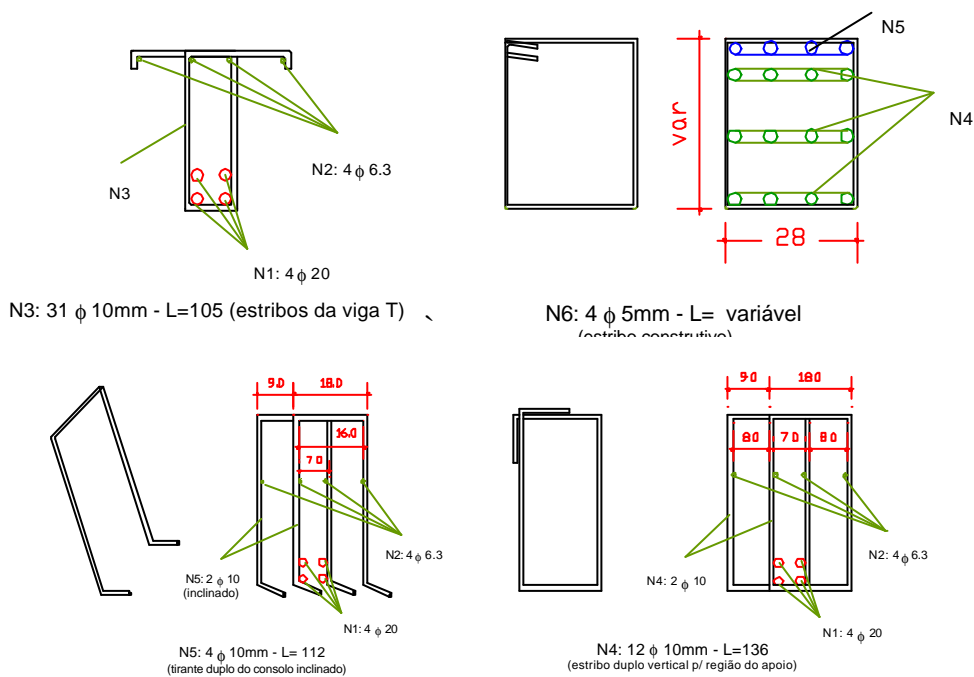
Detalhe das armaduras na seção transversal da VFC
